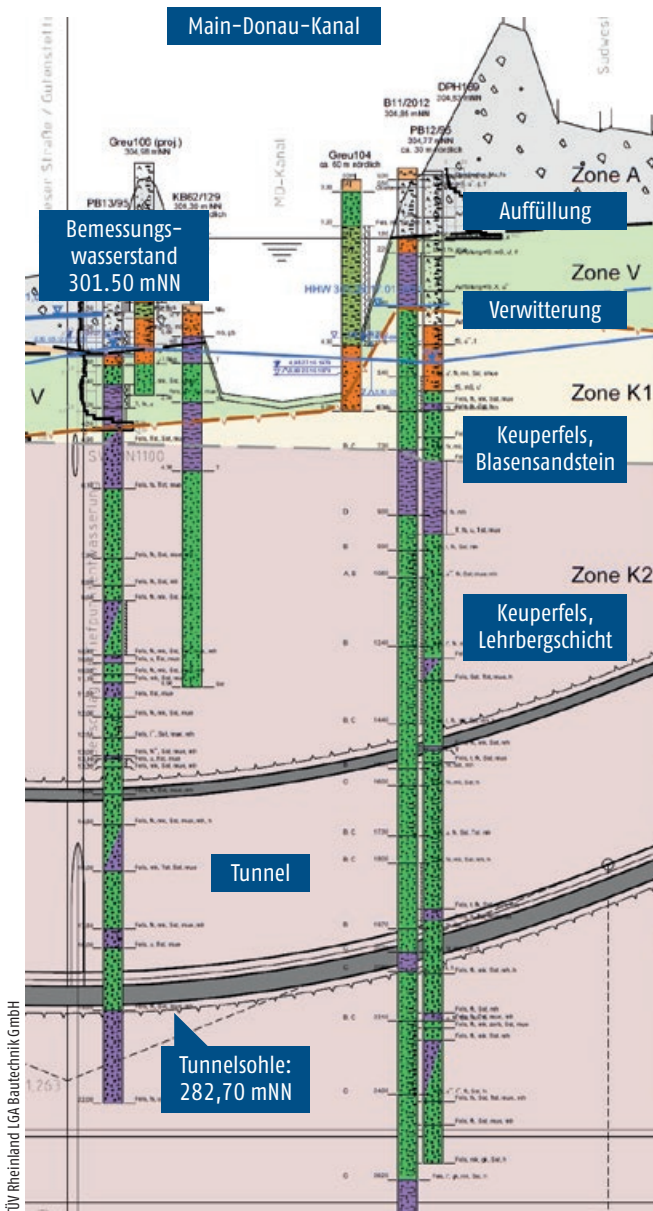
Baugrund mit Darstellung Tiefenlage des Tunnels
